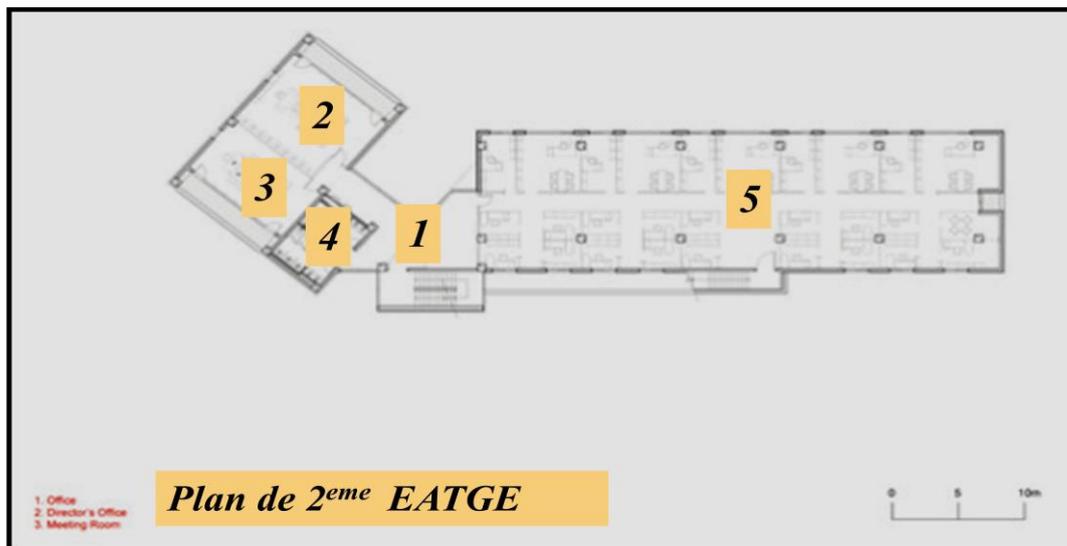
Plan de 2^{ème} étage du centre.⁸⁴
